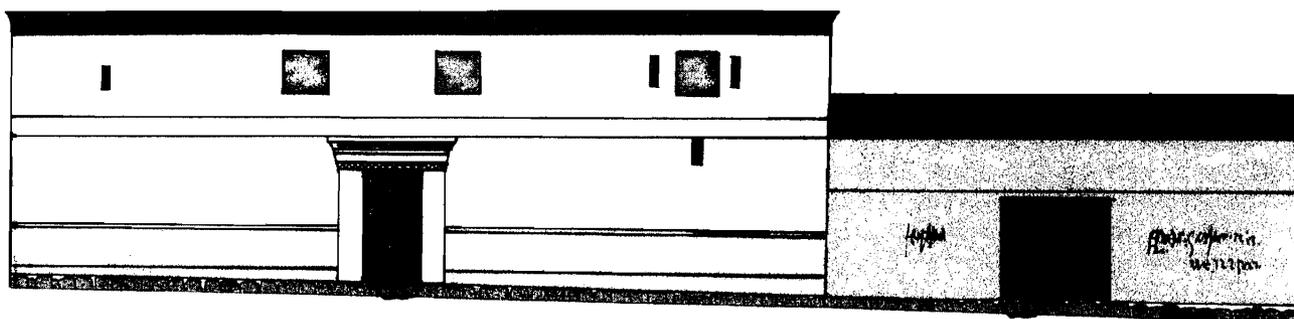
Reconstrucción de la fachada principal de la Casa de la Fortuna y la taberna ubicadas en la Insula B.
